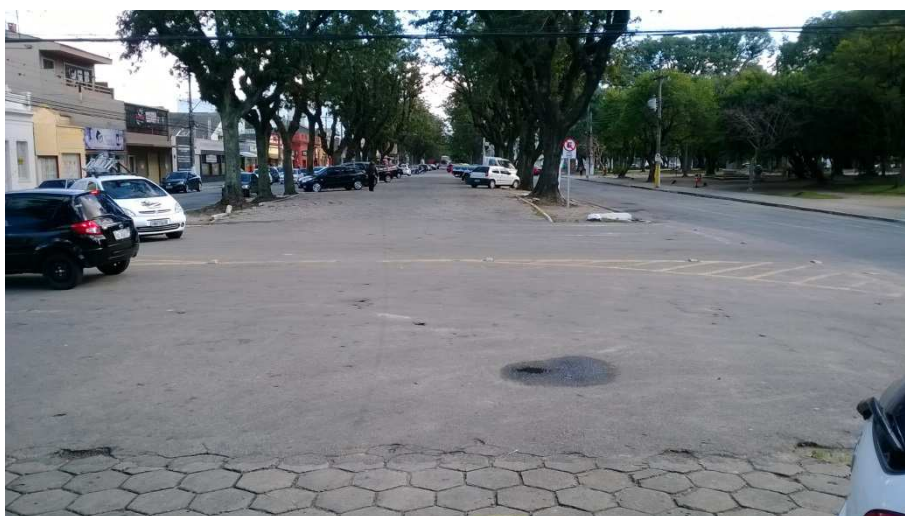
Vista do Canteiro atual, no cruzamento com a Rua Anchieta
